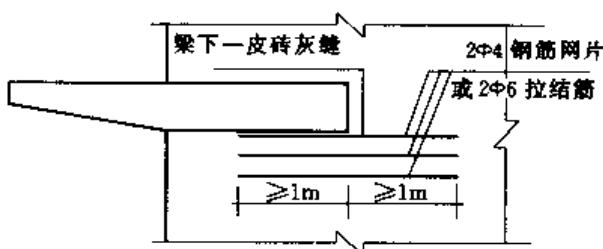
顶层挑梁末端钢筋网片或拉结筋
